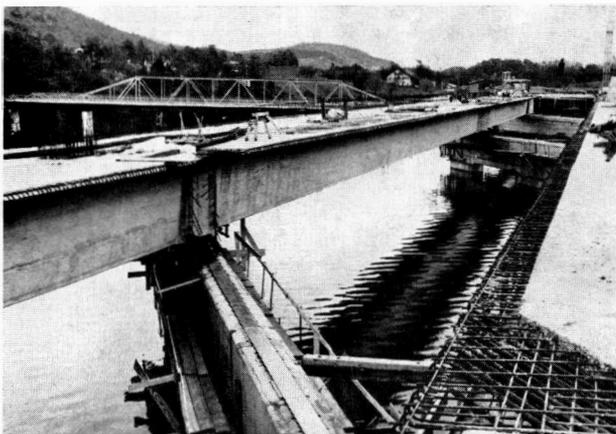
Bauzustand, im Hintergrund ein bereits in die definitive Lage querverschobener Träger
